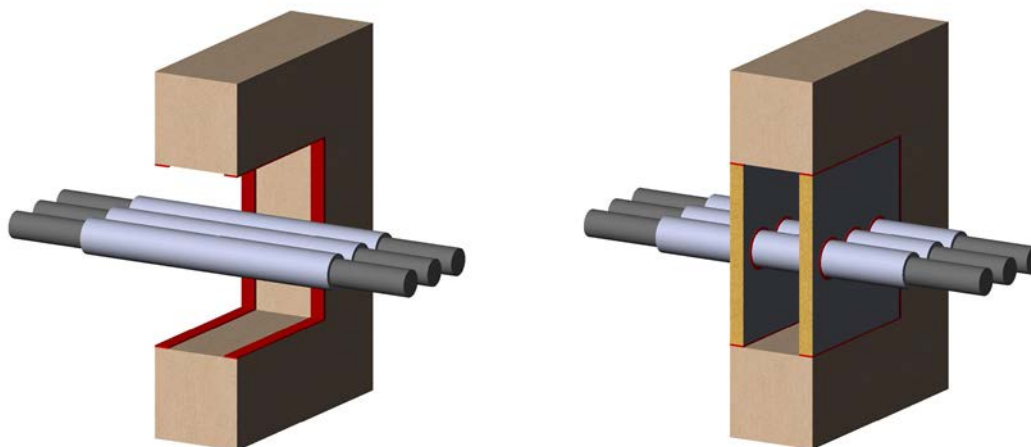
Принципиальная схема монтажа проходки кабельной универсальной огнестойкой «TEHSTRONG FIREWALL КР» («ТЕХСТРОНГ ФАЙЕРВОЛ КП»).
